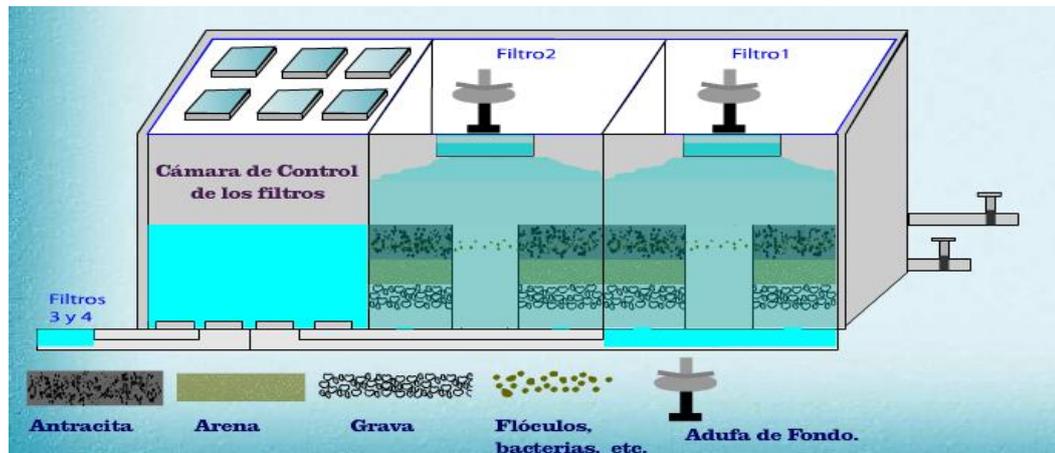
Módulo de Filtración Planta AGUAPEN E.P
